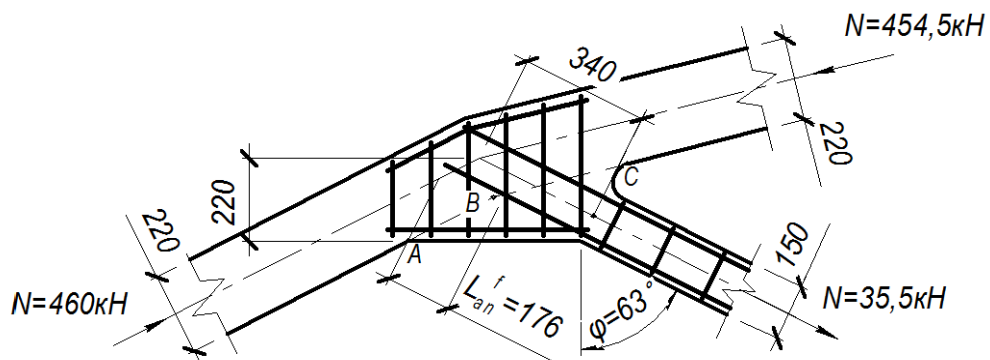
Розрахункова схема 1-го проміжного вузла верхнього поясу
